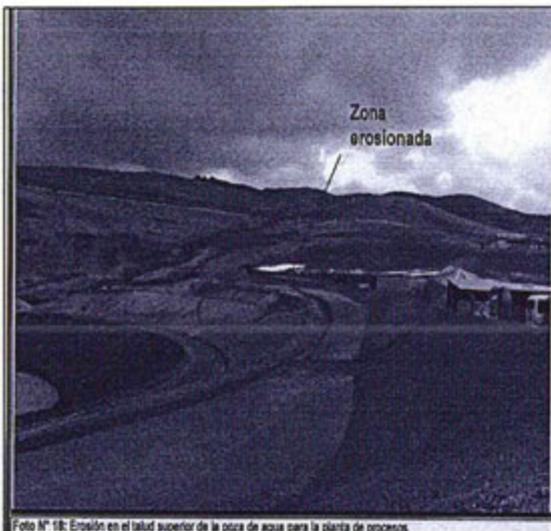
Erosión en el talud superior de la poza de agua para la planta de procesos
